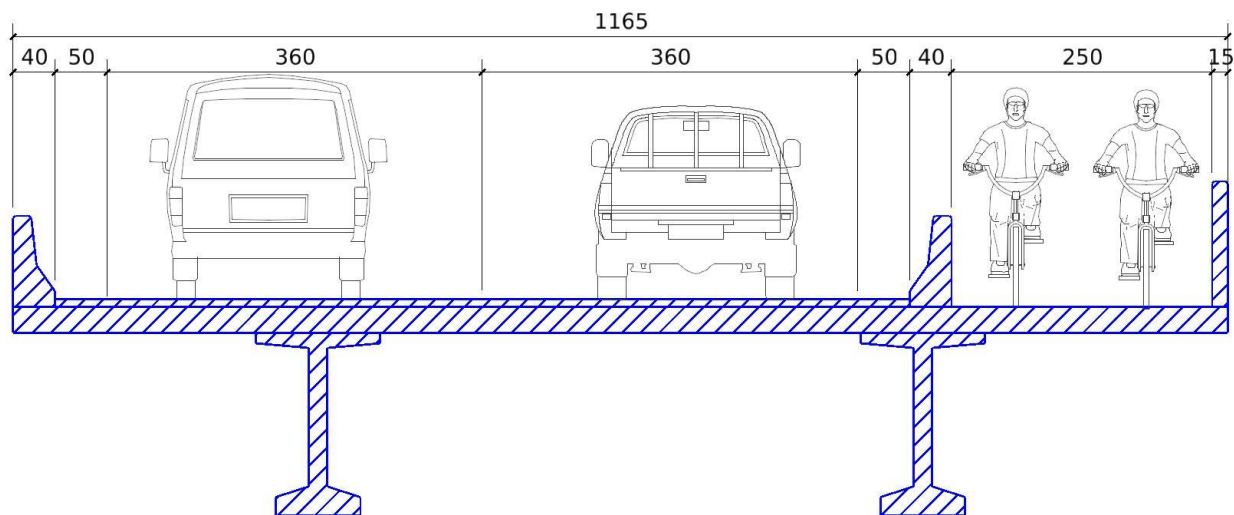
Seção Transversal Tipo da Ponte na DF-140
